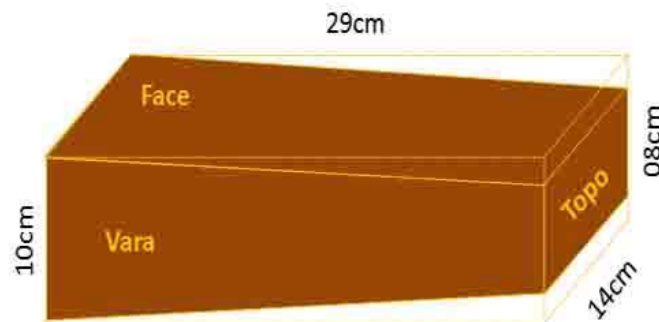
Esquema do tijolo do arco da construção de 1842-1852, Hospício de Pedro II.
